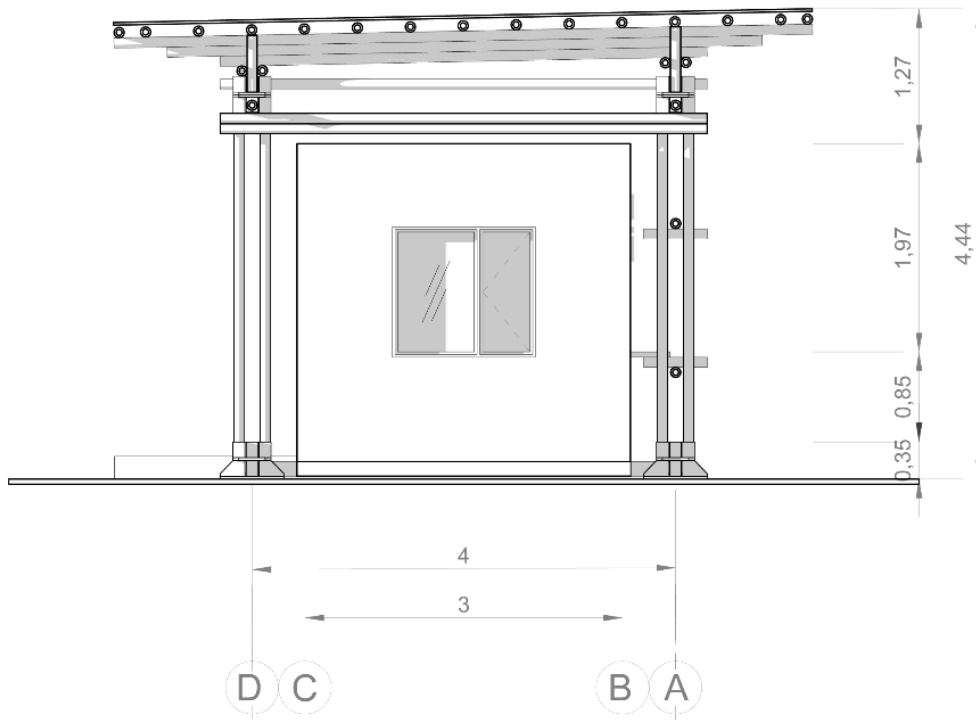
Fachada Norte. Fuente: Gerardo A., 2022.
